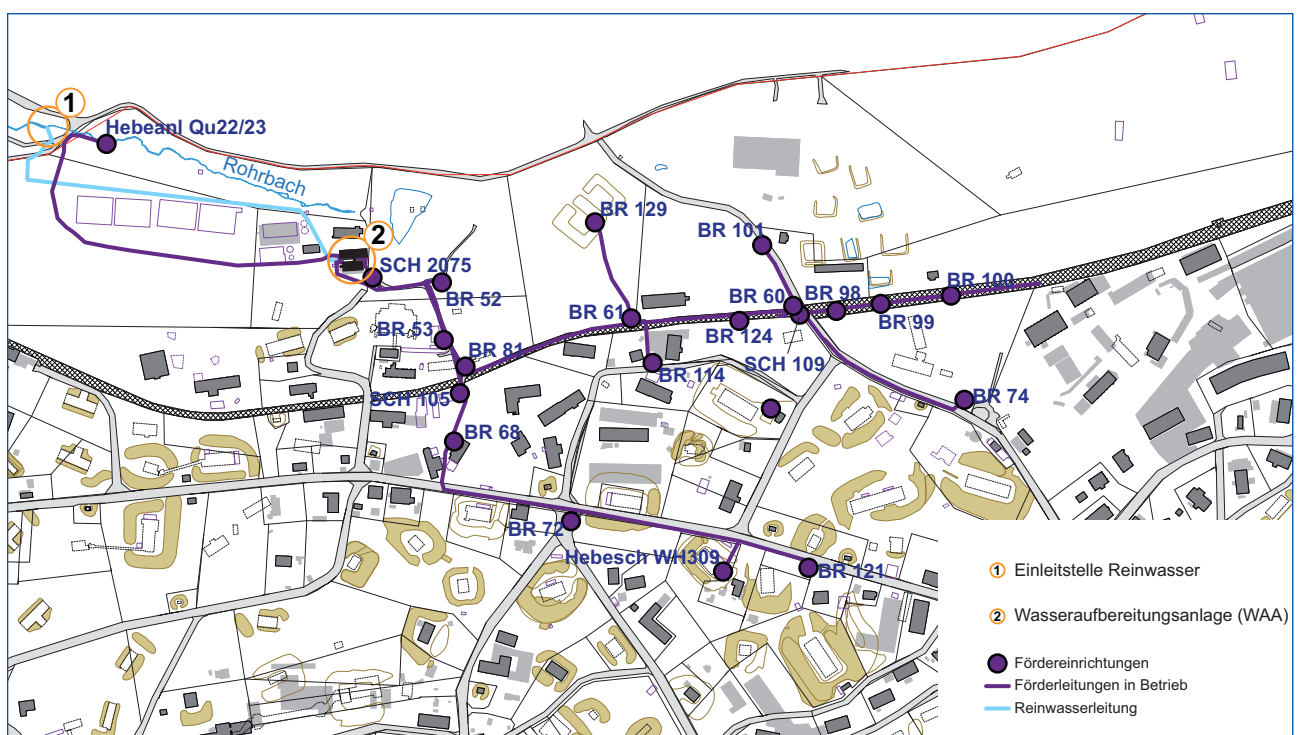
Lageplan der Elemente der hydraulischen Sicherung
